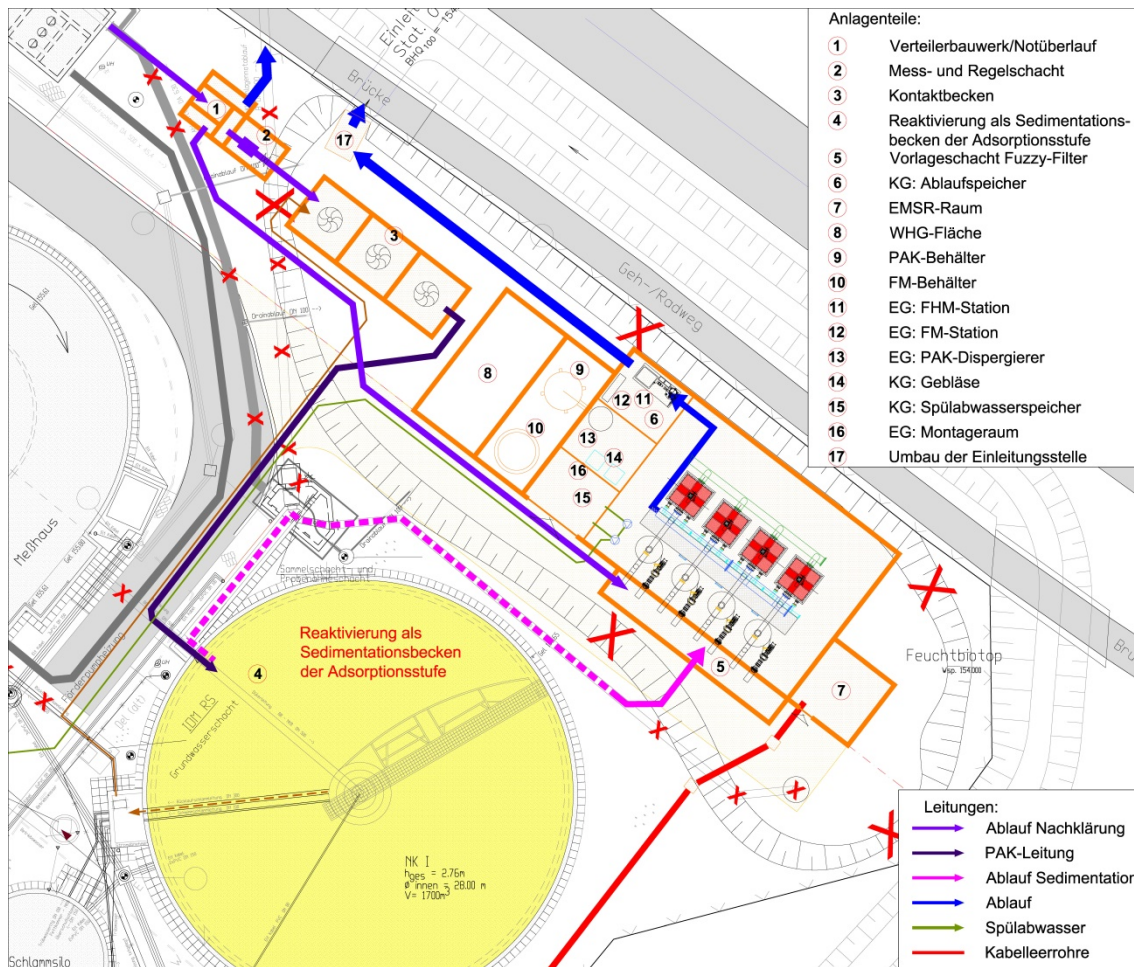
Lageplan KA Barntrup - Variante IIb - PAK-Stufe mit Sedimentationsbecken (Umbau)
